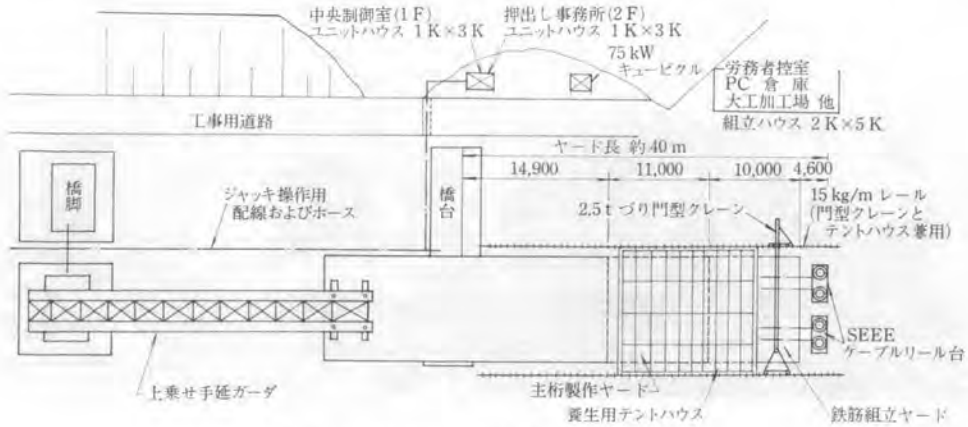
A₁ 側押しヤード配置図 (Bライン施工時)
